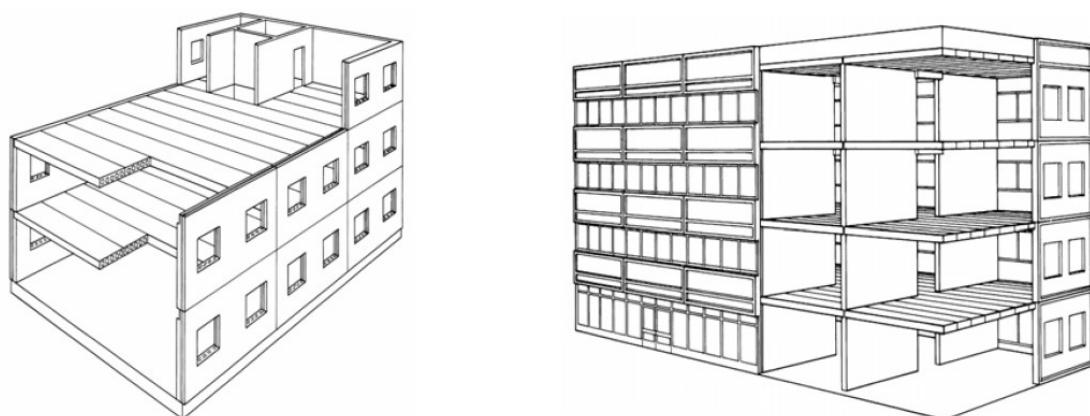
Painéis estruturais de fachada e painéis estruturais de interior (Acker, 2008)
